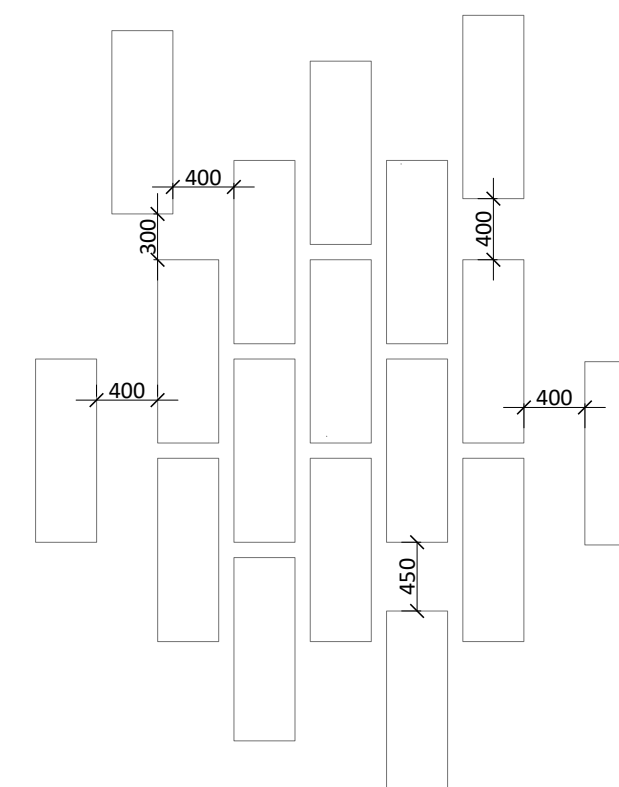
DETAIL KLADEŇÍ POD LAVIČKOU S OPĚRADLEM
